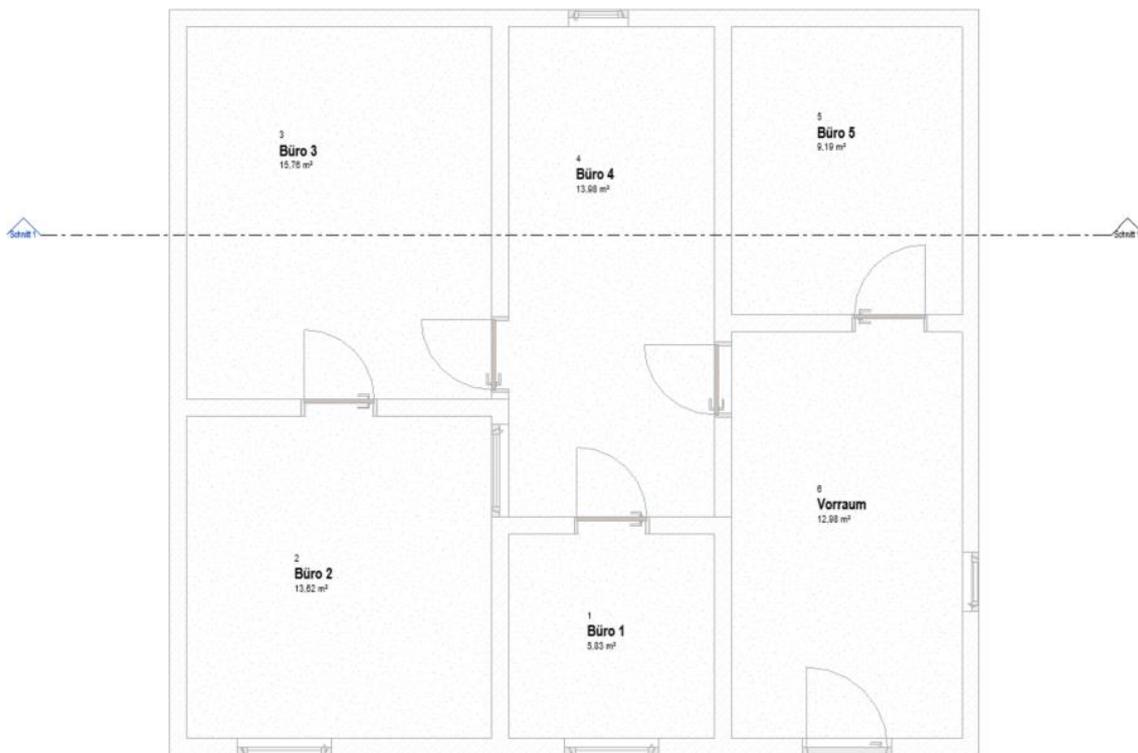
Grundriss BIM-Modell OIB RL 3 - 9.1.1
